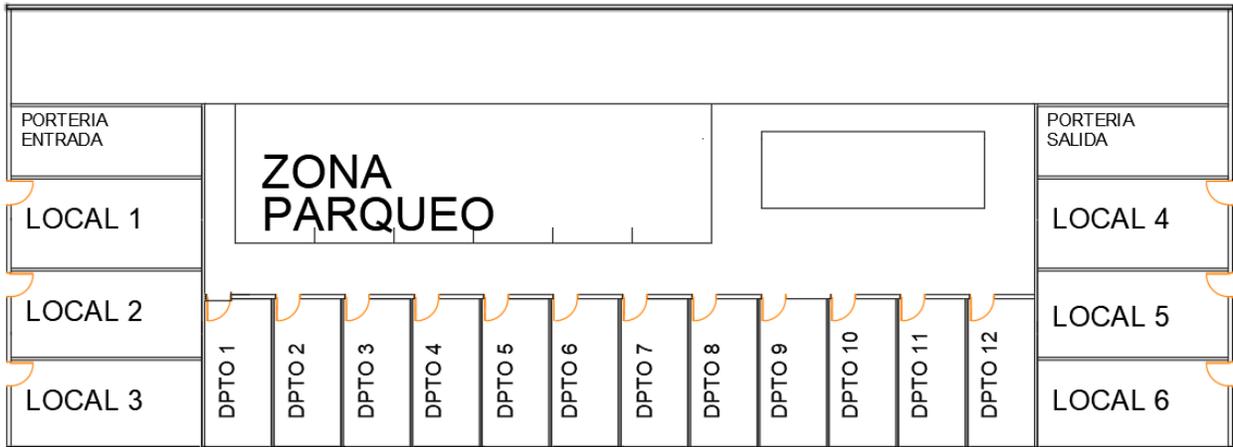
Vista en planta de primer piso, Plano Arquitectónico.
